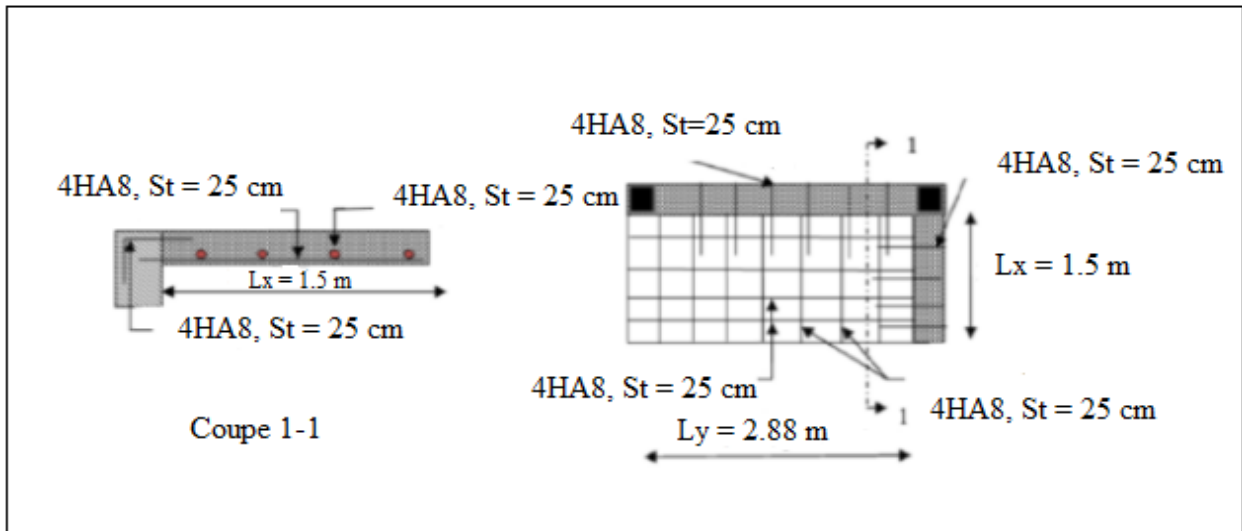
Schéma de ferrailage de la dalle sur 2 appuis
